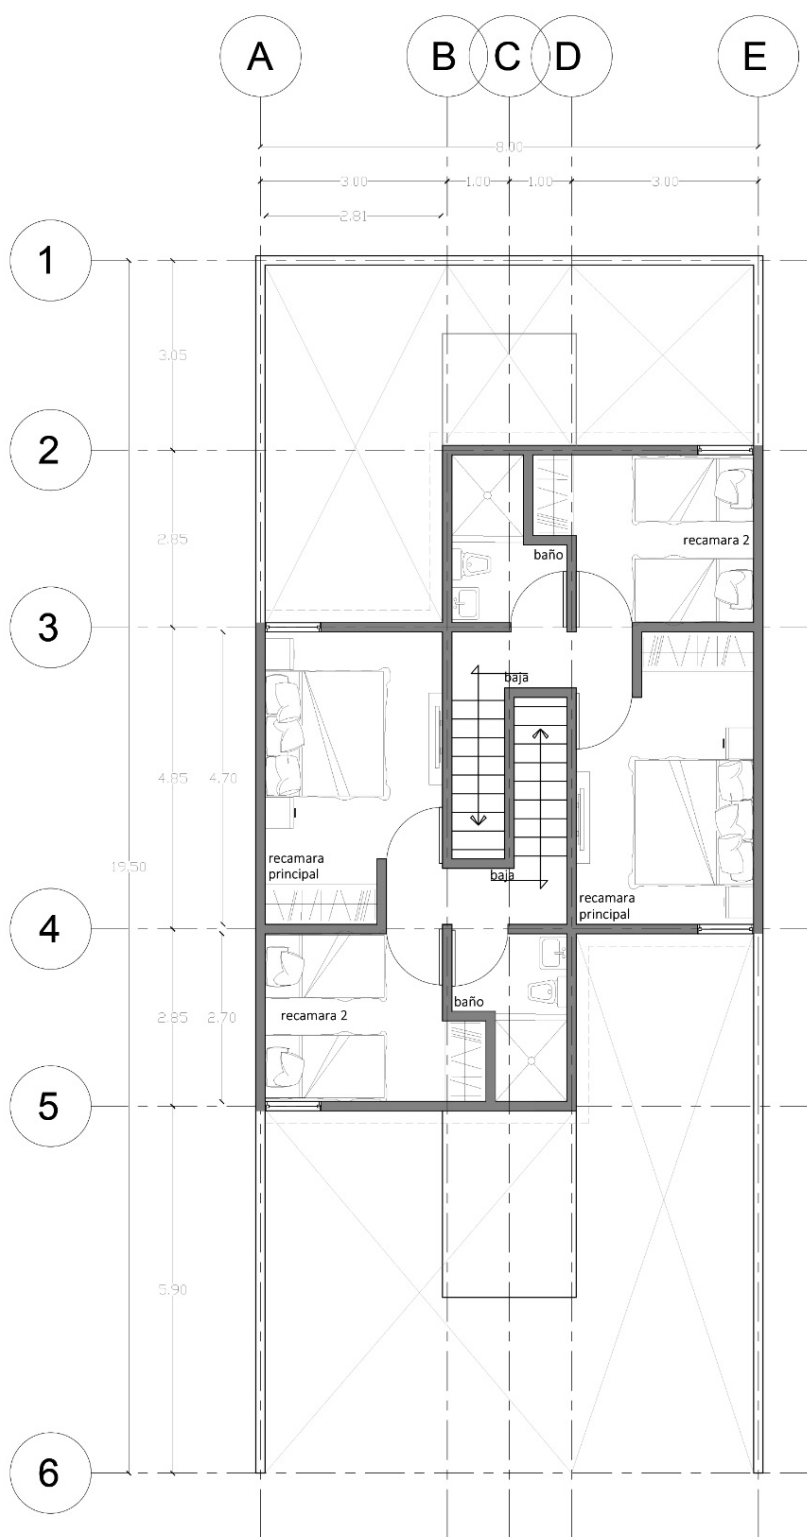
Planta Alta De Diseño Original De Viviendas De Manzana De Estudio. Fuente: captura digital de planos originales entregados a los dueños
